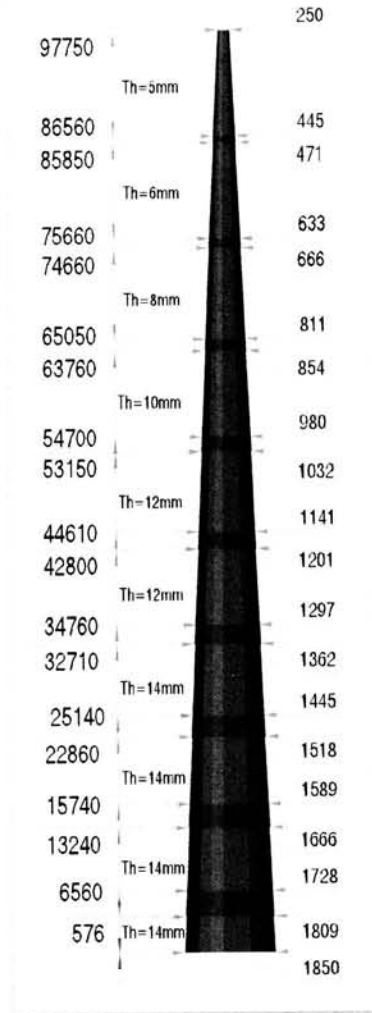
Dimensões de “Met Mast” de 97.75m a instalar em França
